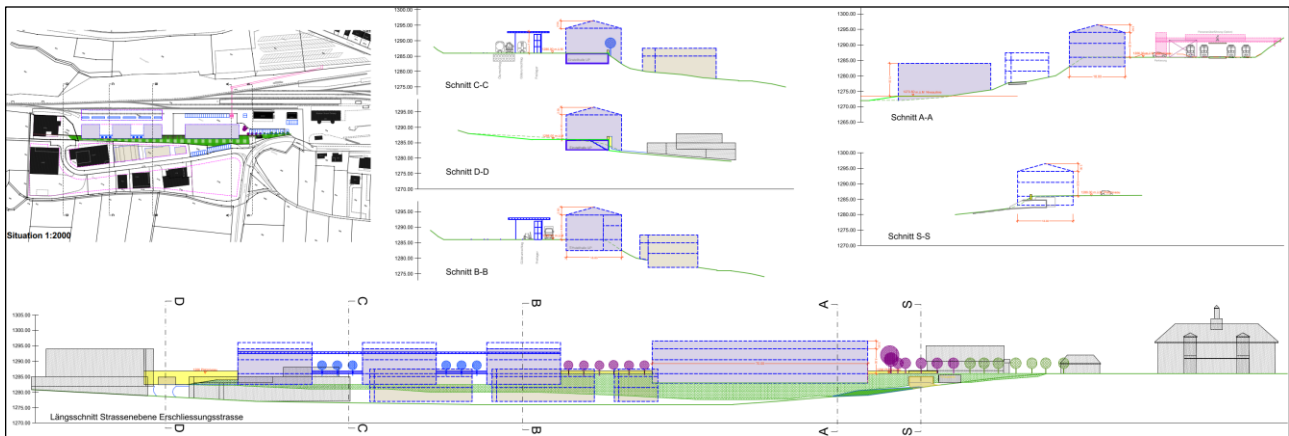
Quartierplan 2025 - Gestaltungsplan Profile
